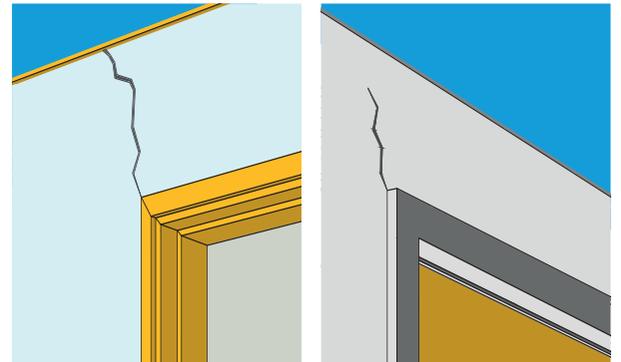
Ejemplos de fisuras sobre jambas y puertas (Fuente: CDT).
